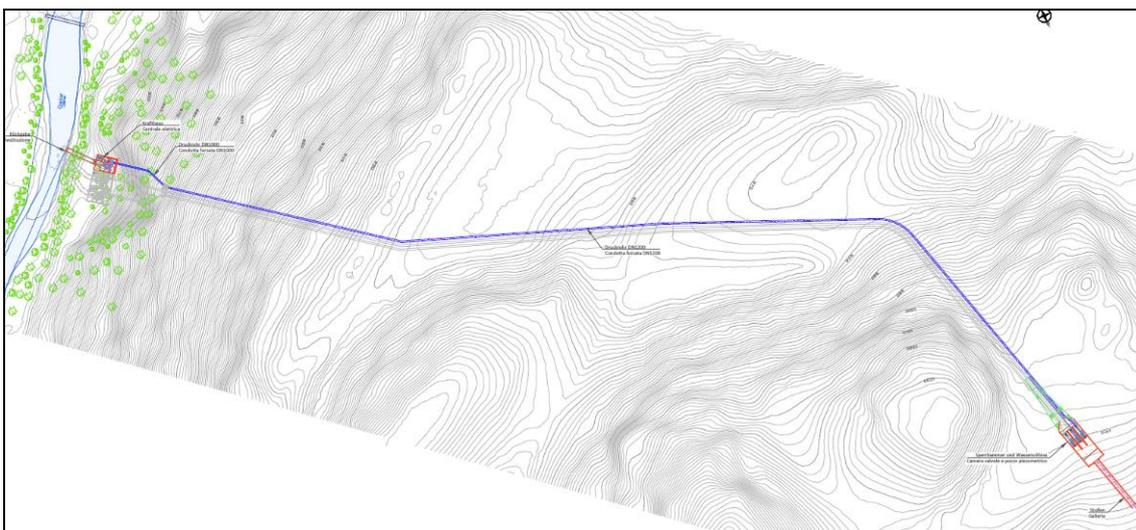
Planimetria di progetto: condotta forzata (fonte: Tavole progettuali)
